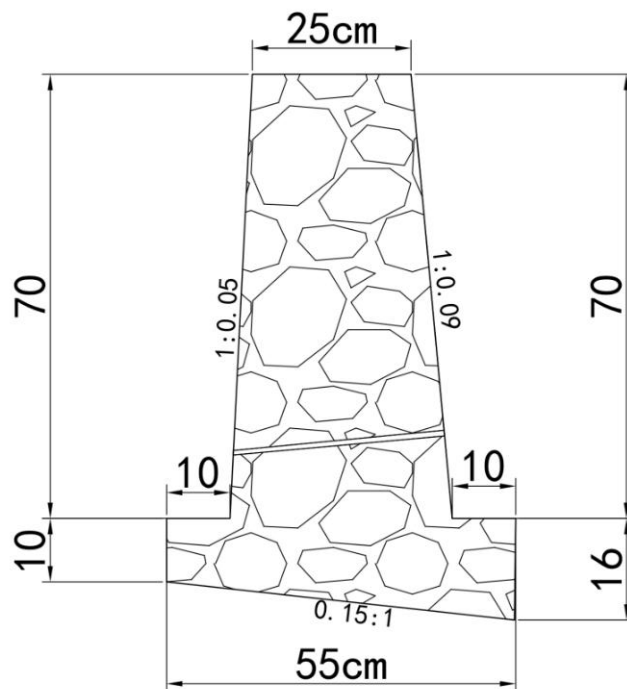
露天采场马道挡土埂断面图（单位：cm）
